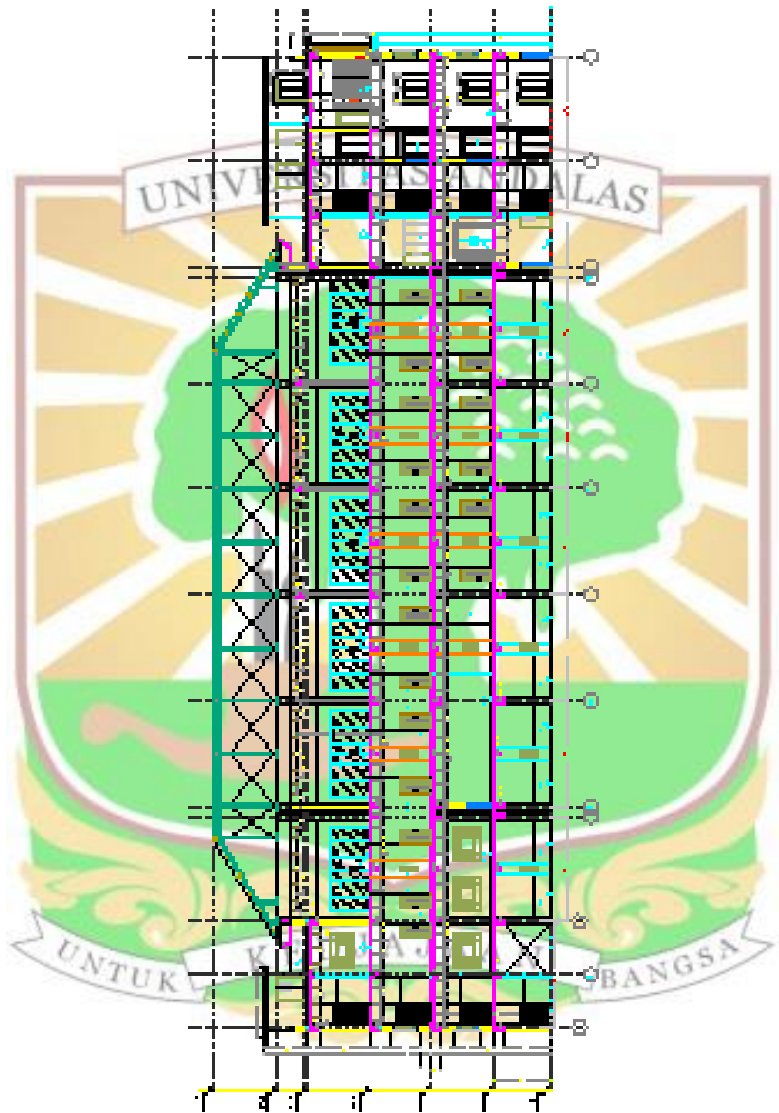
Denah Lantai 4 Gedung Hospitality Center
